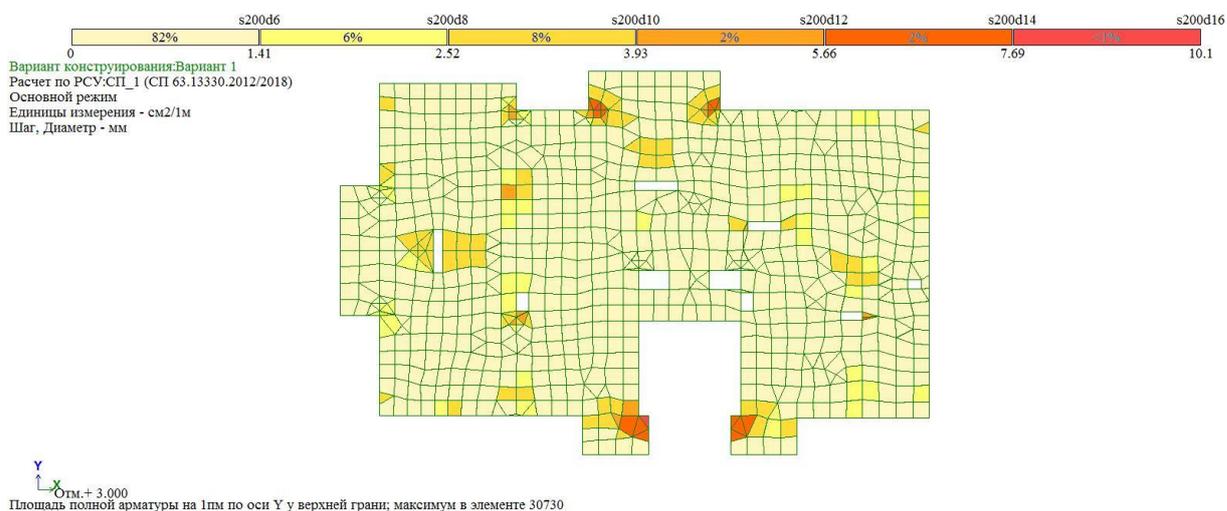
Верхняя арматура в плите перекрытия вдоль оси Y
